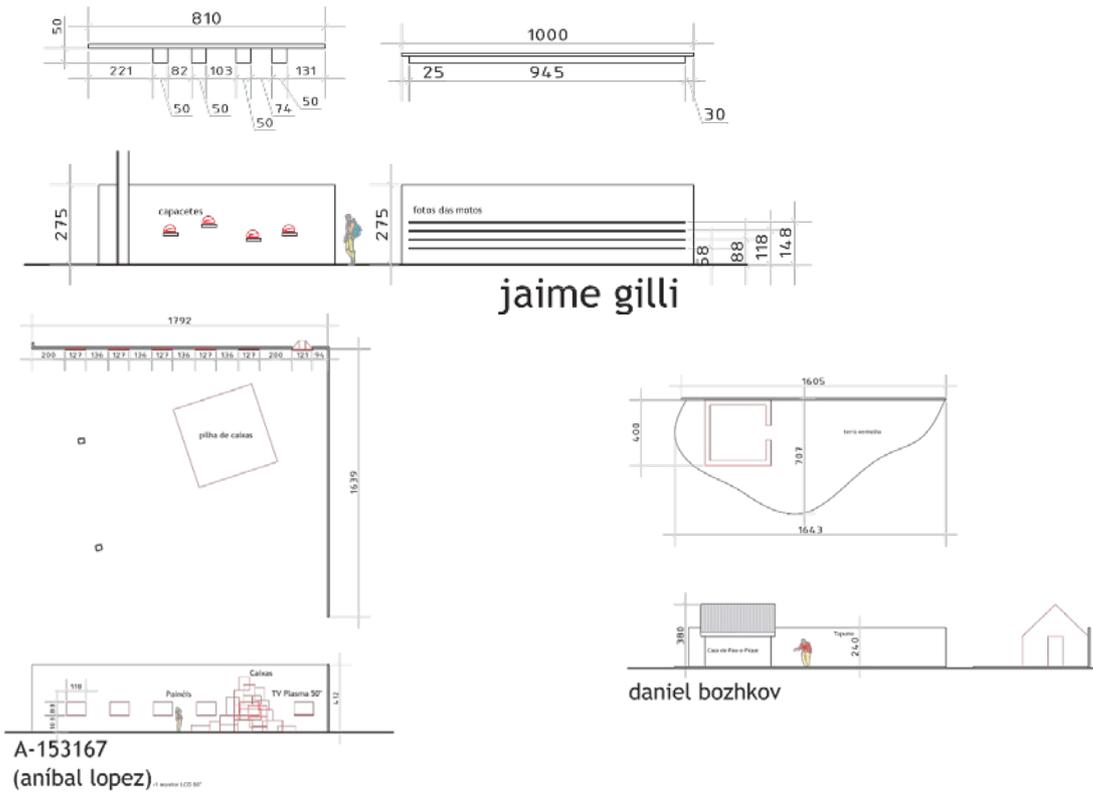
Planta baixa e corte indicando disposição das obras DE Jaime Gilli, Anibal Lopez e Daniel Bozhkov
